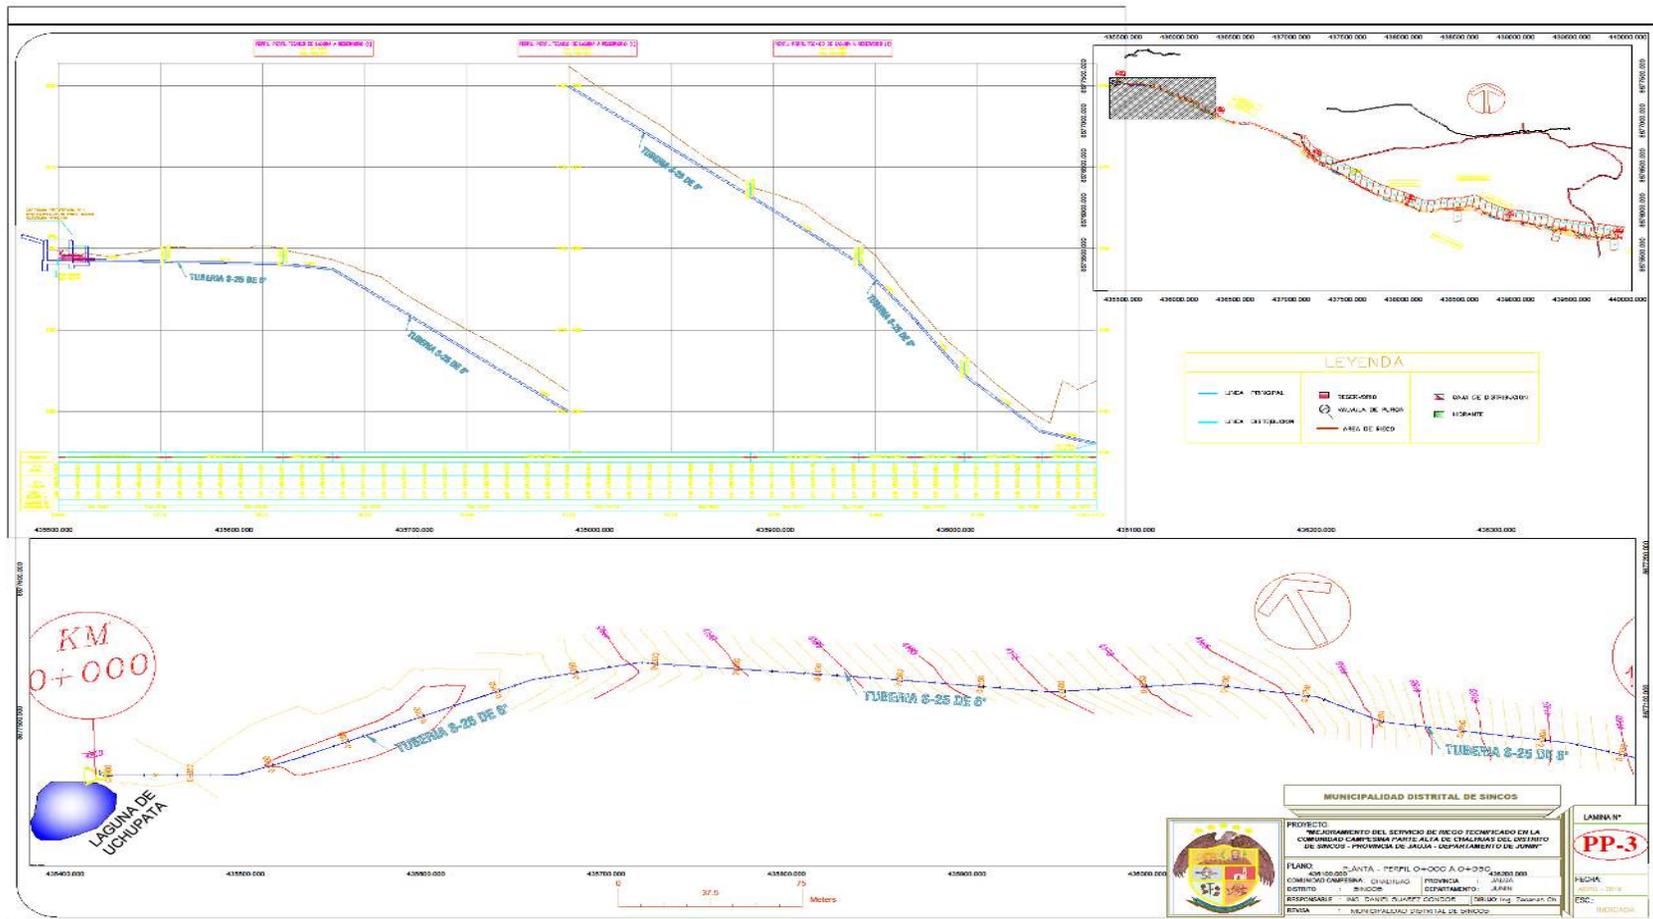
Plano de planta - perfil de canal Prog. 0+000 a 0+950.
